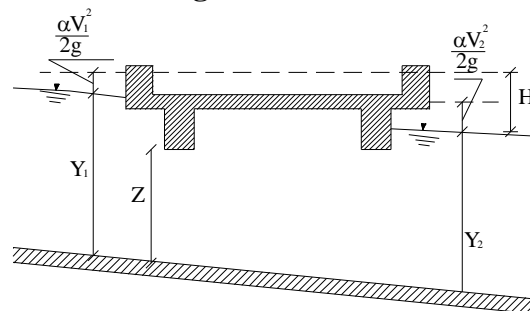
Sezione schematica di un ponte in pressione – Schema di calcolo.
